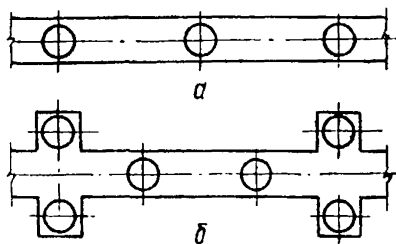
Схемы расположения свай под ленточными фундаментами;
